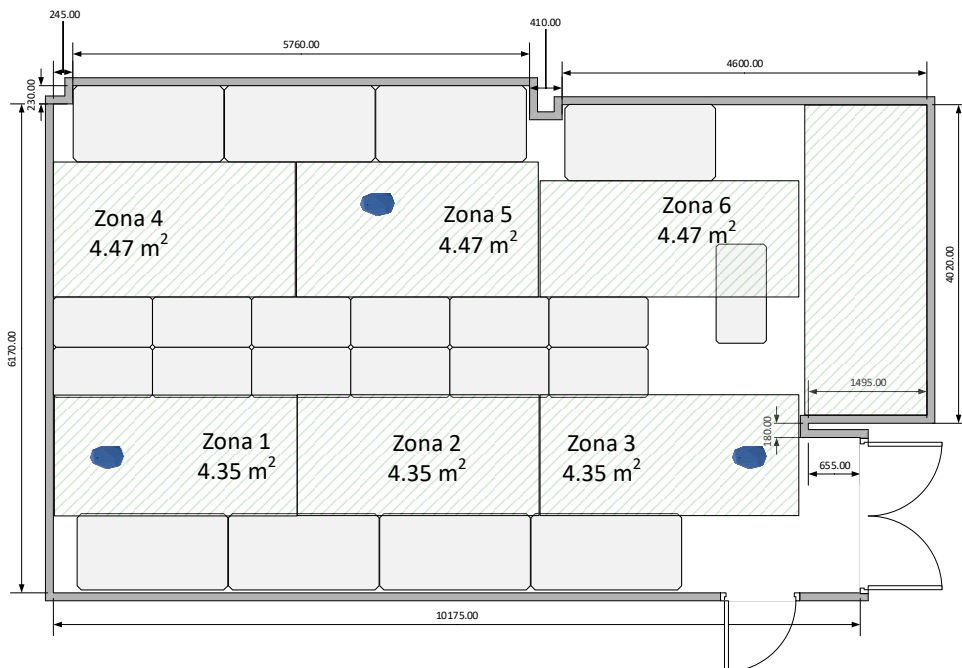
Área de trabajo con 3 beacons, segunda ubicación en el techo.
